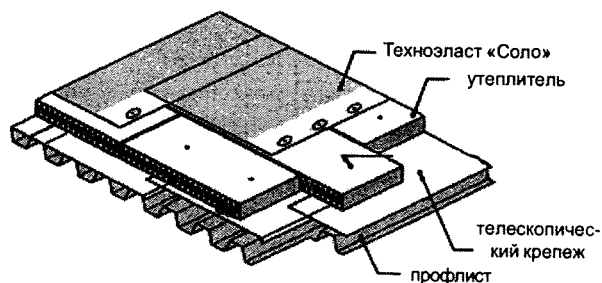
Монтаж кровельного рулонного материала механическим креплением шва на основание из стального профлиста
